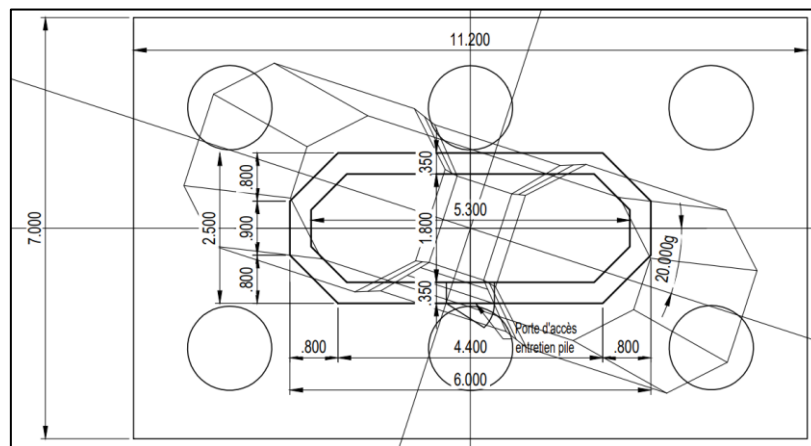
Vue en plan pieds piles P3 et P4 viaduc de Vienne
